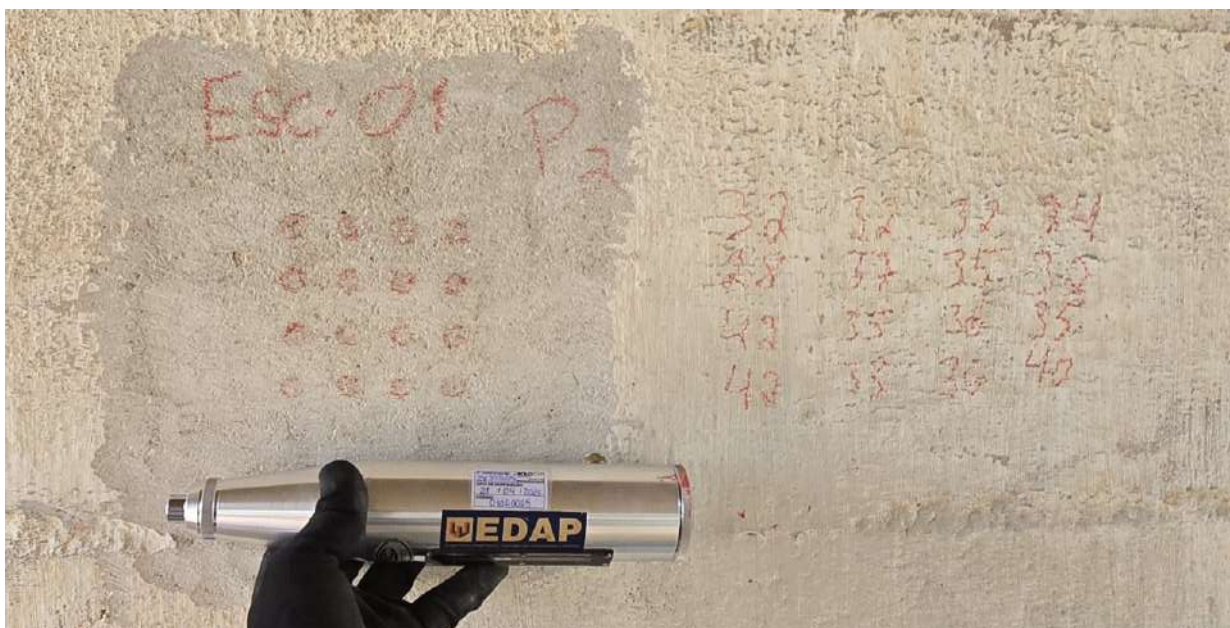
Ensaio de esclerometria ESC-1 no pilar P2 face entre P2 e encontro 2.
